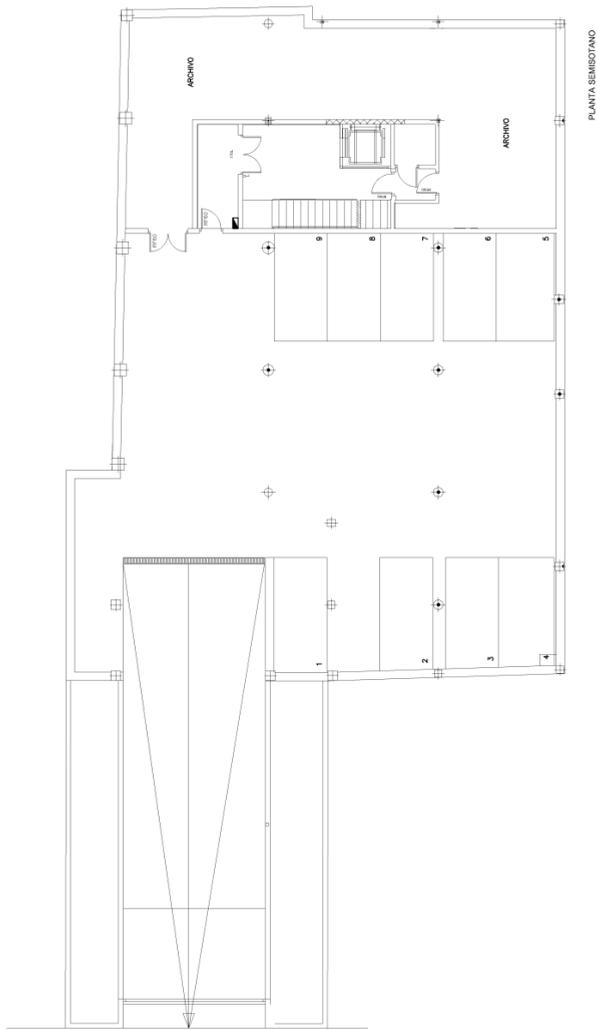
Planta sótano (garaje). 2002. AutoCAD.
